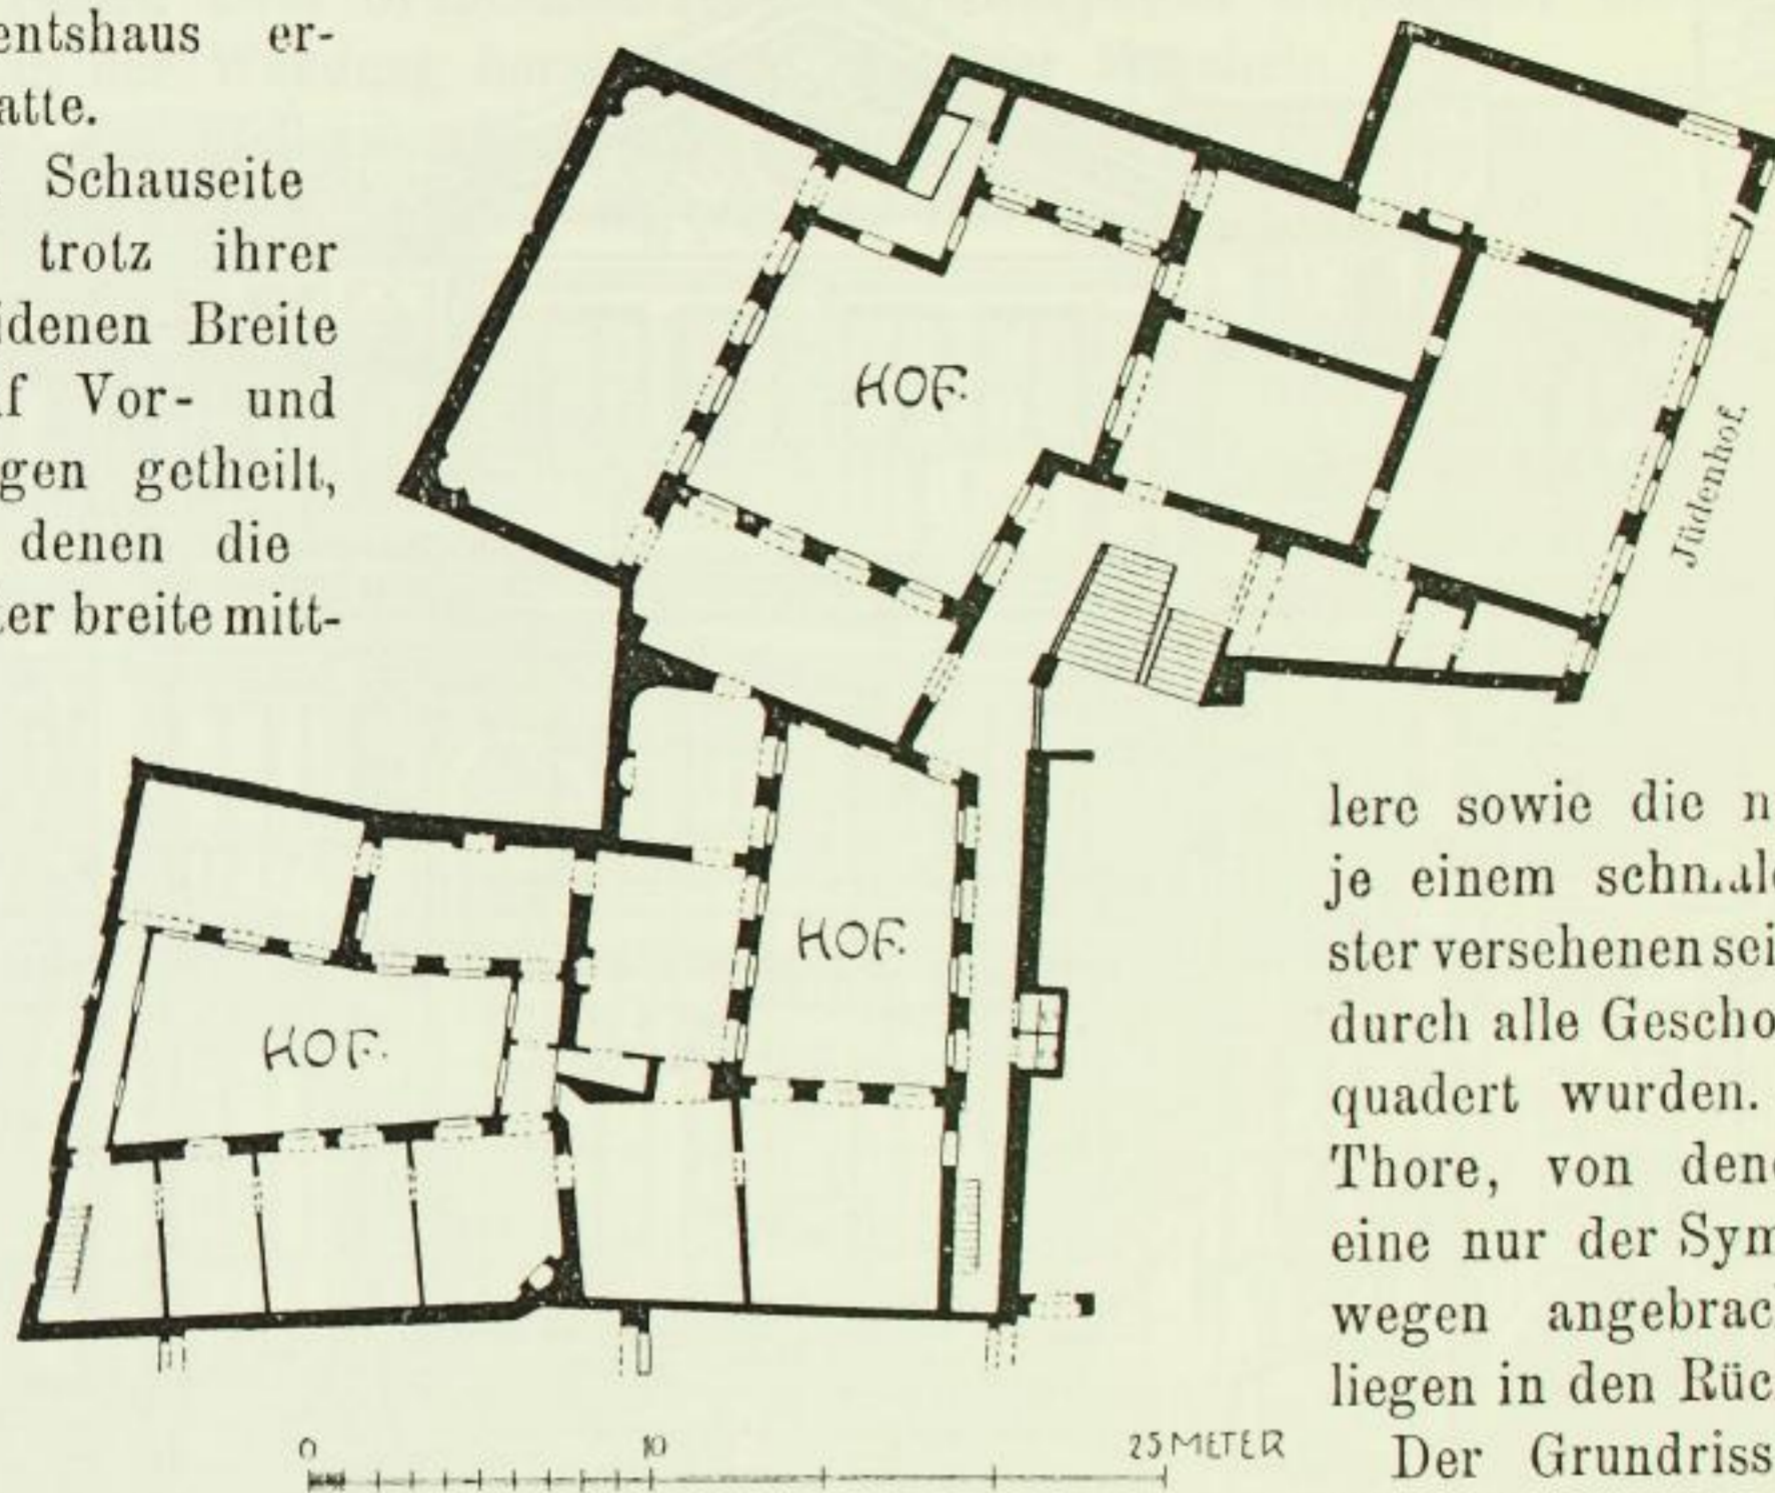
Regimentshaus, Grundriss des Hauptgeschosses.
